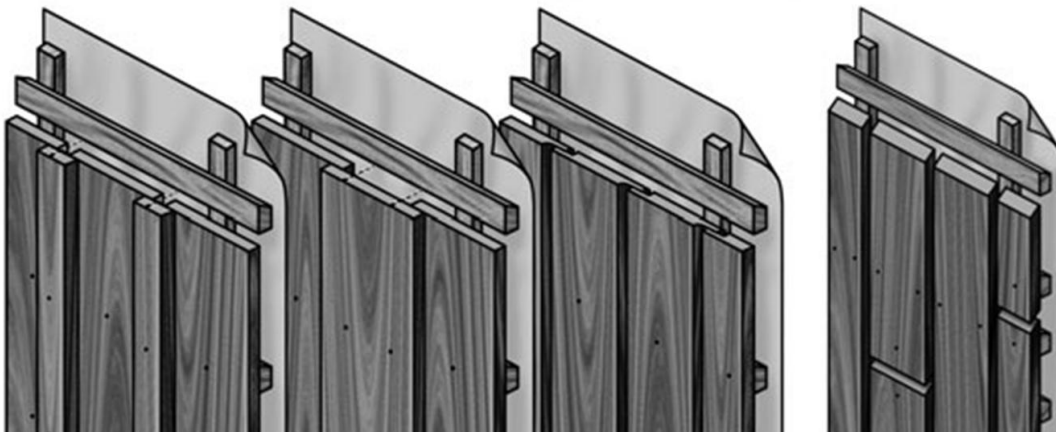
Profilering verticale gevelbekleding. V.l.n.r. opdekwerk, opdekwerk en rabat met halfhoutse overlap (Channel siding), verticale open gevelbekleding [41]
